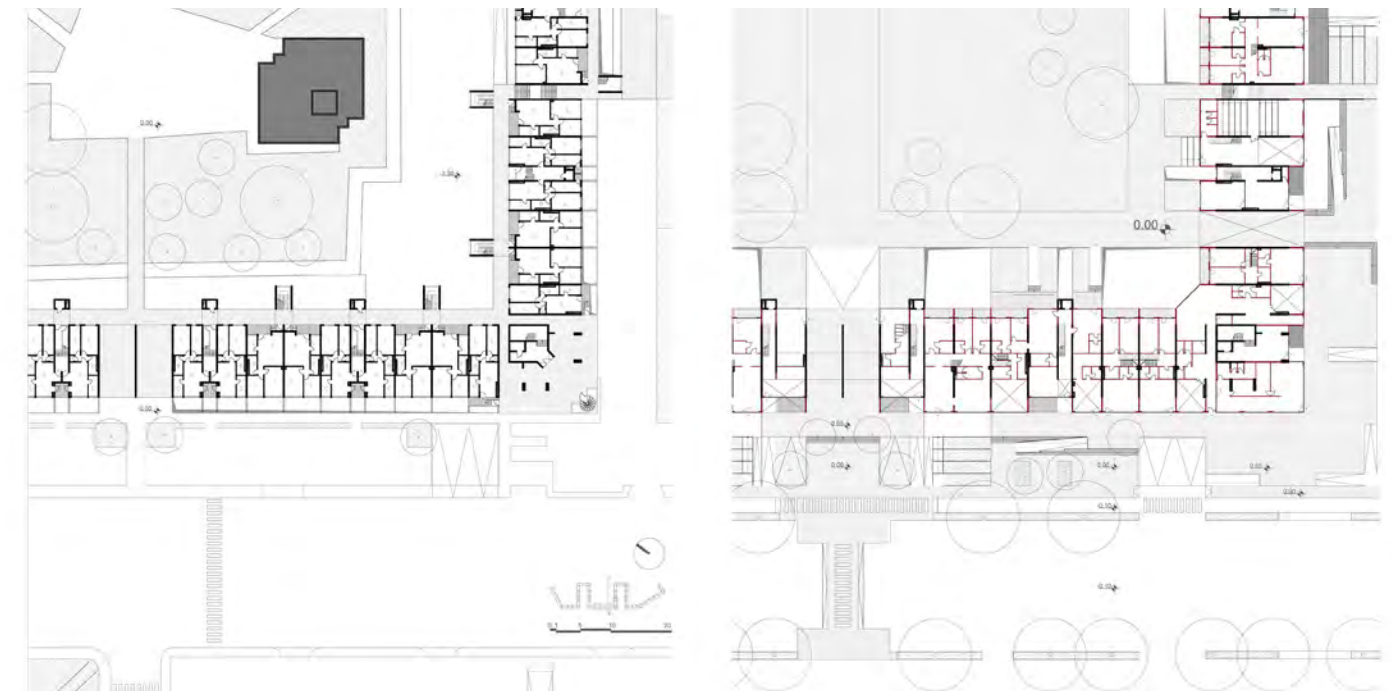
Pianta stato di fatto e stato di progetto di uno stralcio dell'R5
